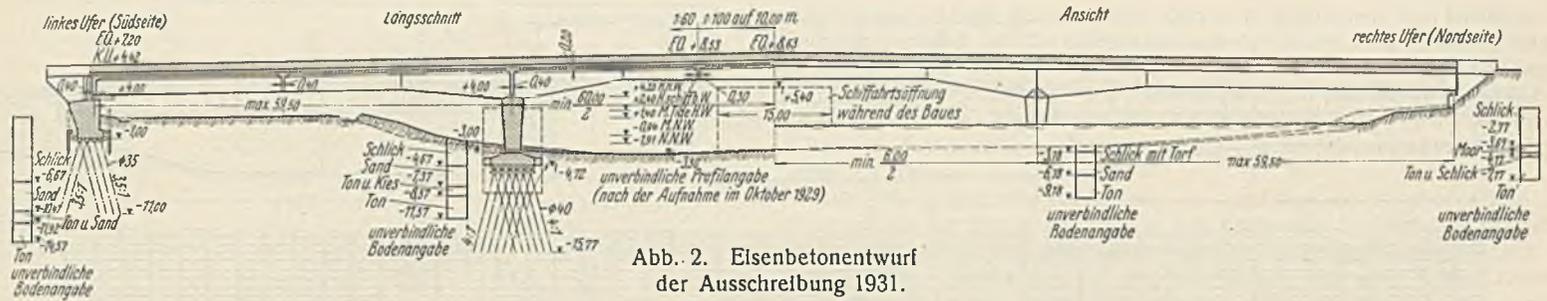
Eisenbetonentwurf der Ausschreibung 1931.
